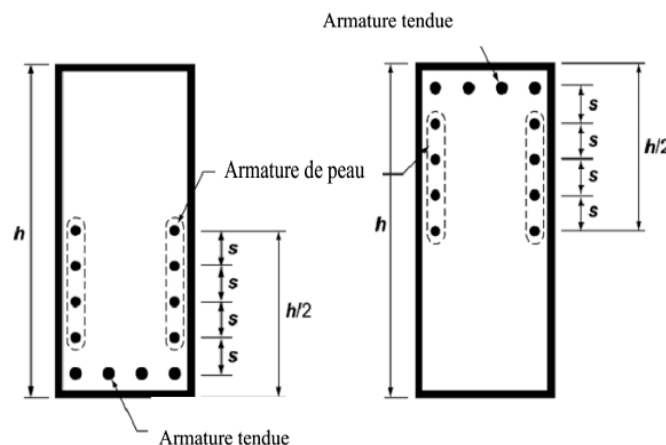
Disposition des armatures de peau pour les poutres de hauteur $h > 91$ cm
